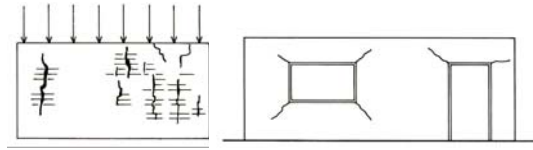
Fissuras causadas por excesso de carregamento nas alvenarias.
